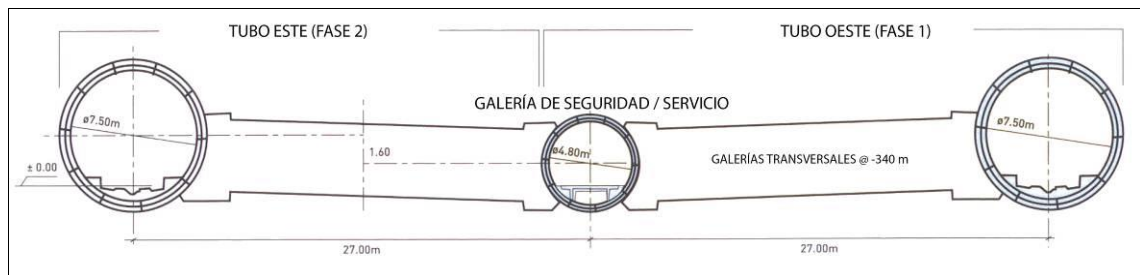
Sección transversal del túnel excavado propuesto (modificado de SECEGSA, 1996).
